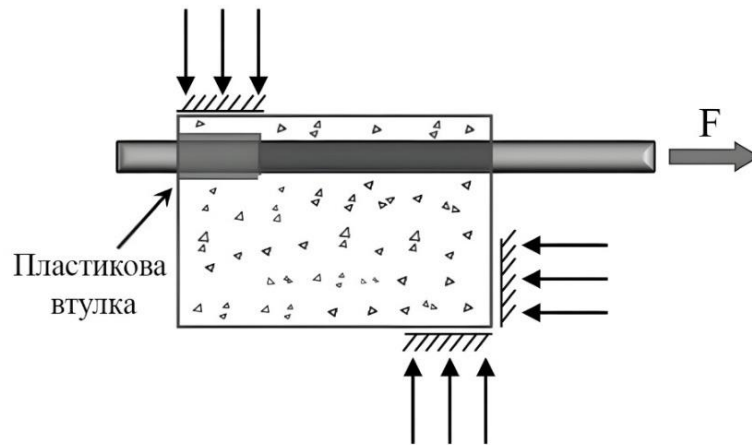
Схема випробування кінців балок для дослідження зчеплення арматури з бетоном [39], [44]
